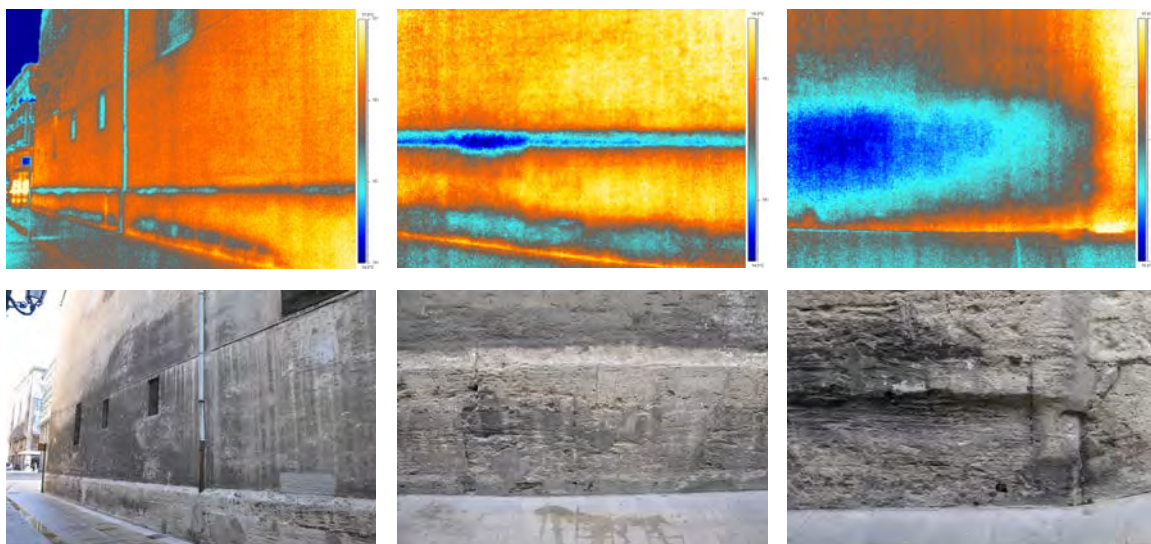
Vista general y detalle de la zona inferior del zócalo.
